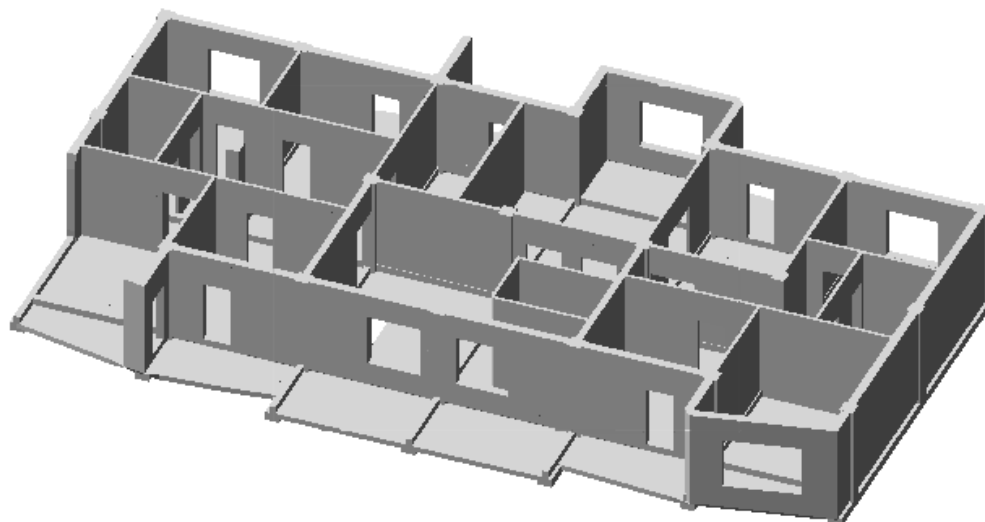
Схема 2-го этажа, локальное разрушение, случай 1
